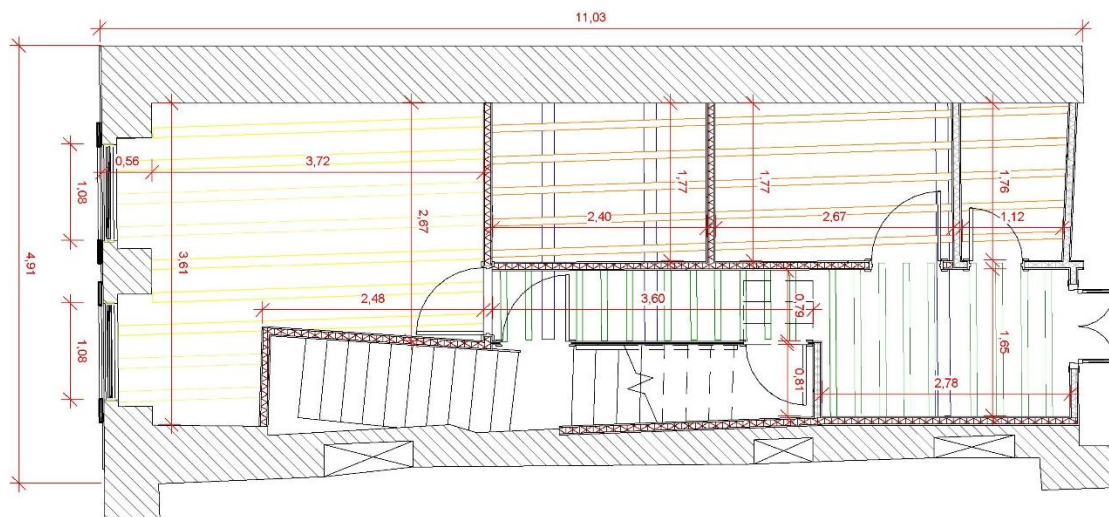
Planta estrutural do pavimento do piso 1 no BIM
